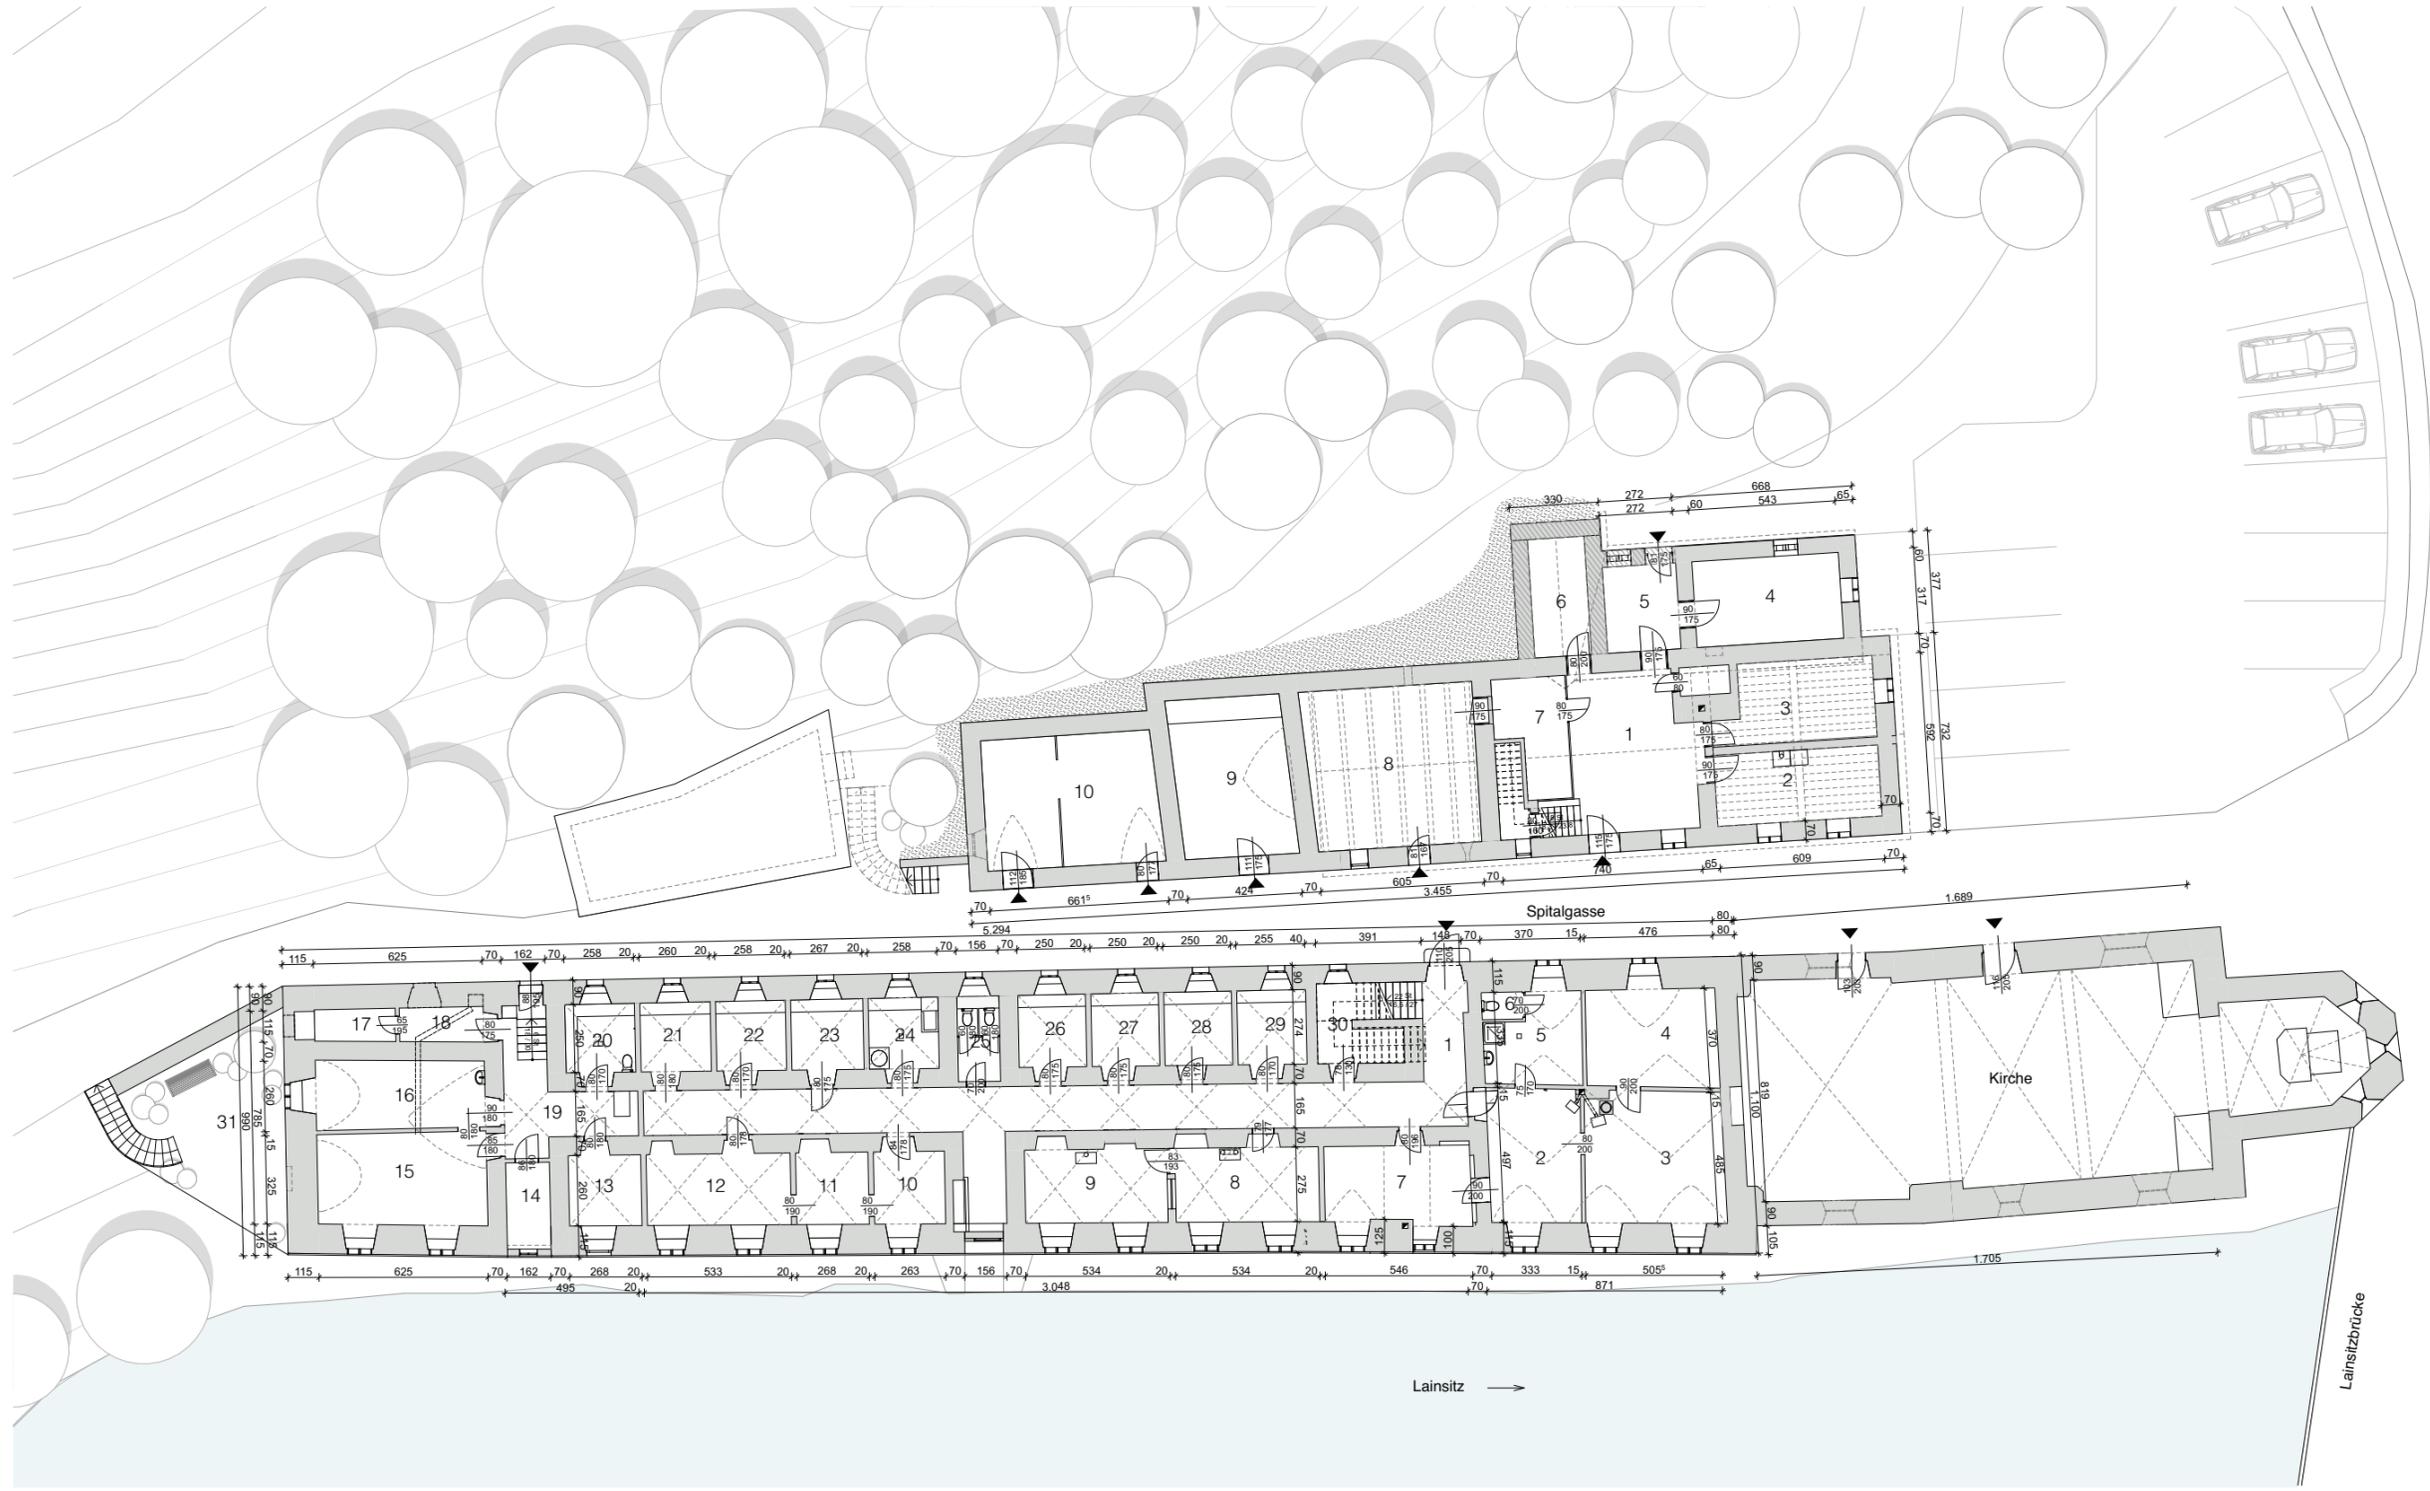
Bestandsplan. Erdgeschoss Spitalstrakt, Spitalkirche und Wirtschaftstrakt
